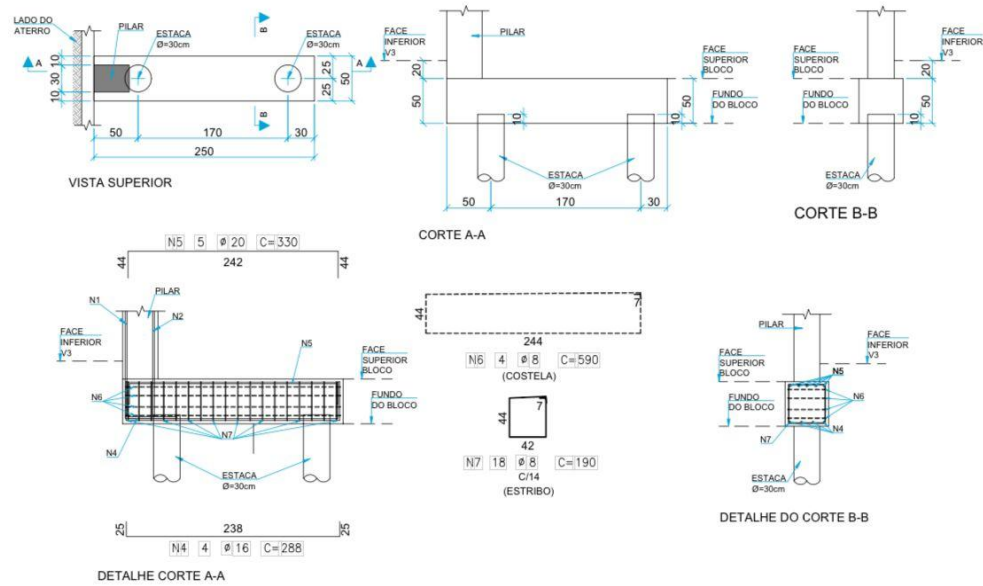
Os detalhes construtivos dos blocos de fundação, estacas e pilares.
